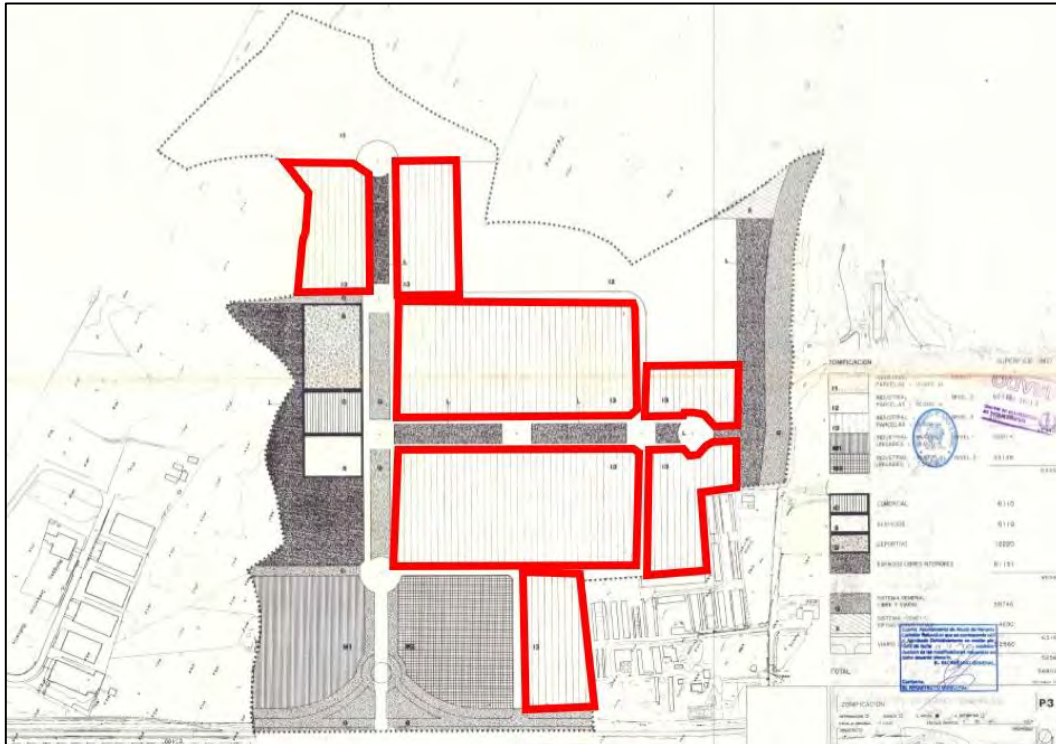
Detalle en Planta de las parcelas del Plan Parcial, se adjunta como Anexo 2
